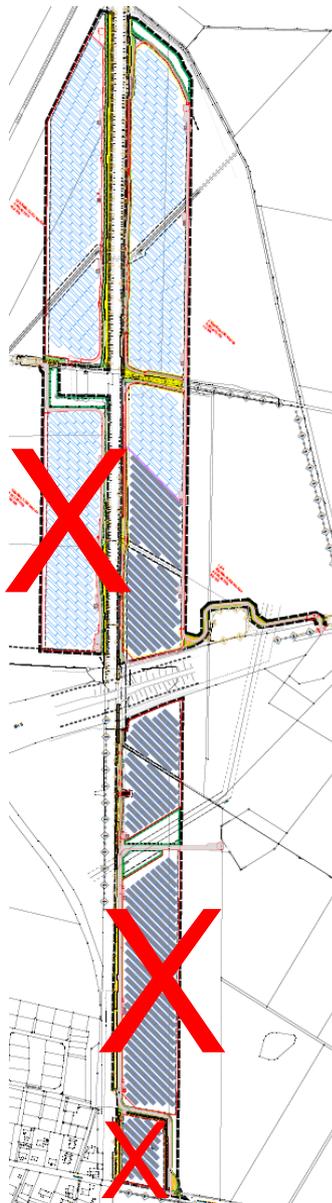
Lageplan des Vorhabens, Planungsstand 20.11.2020, Abbildung unverbindlich, es gelten die Festsetzungen des B-Plans, ohne Maßstab, Quelle: Wattmanufactur.
